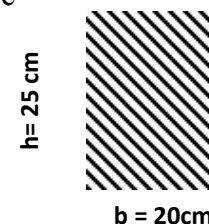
Les dimensions de la poutre de chaînage.
